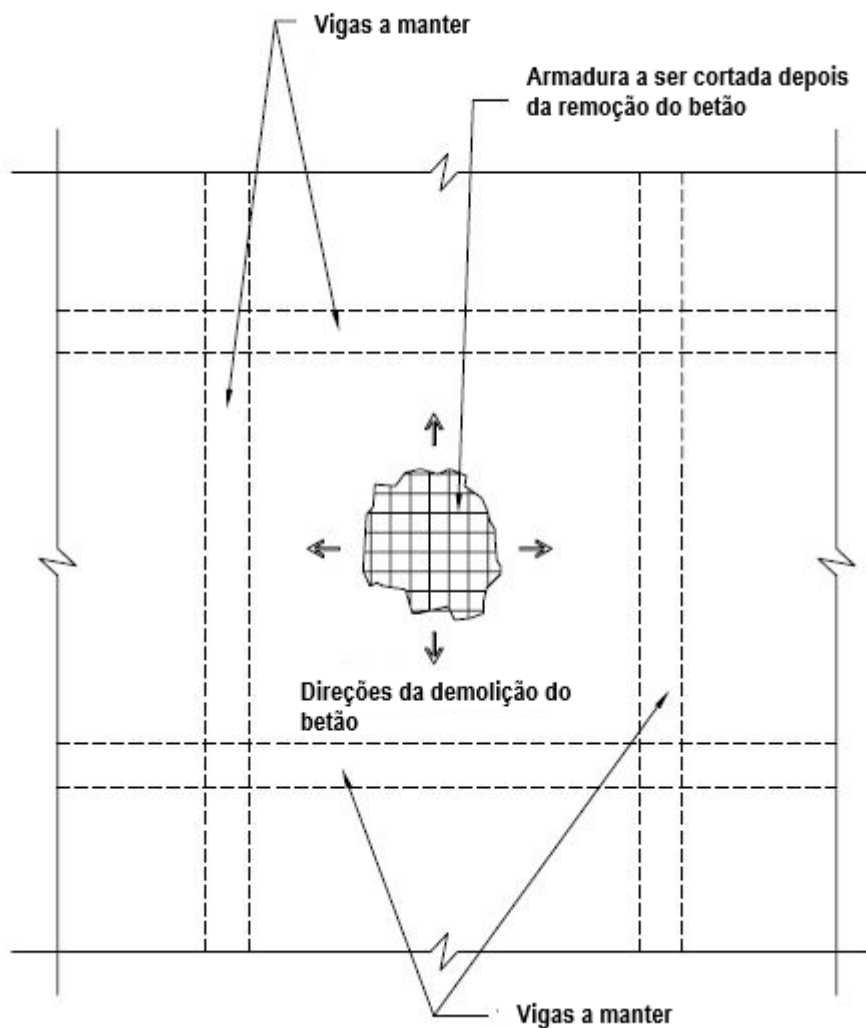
Esquema de demolição de laje armada em duas direções [10]
